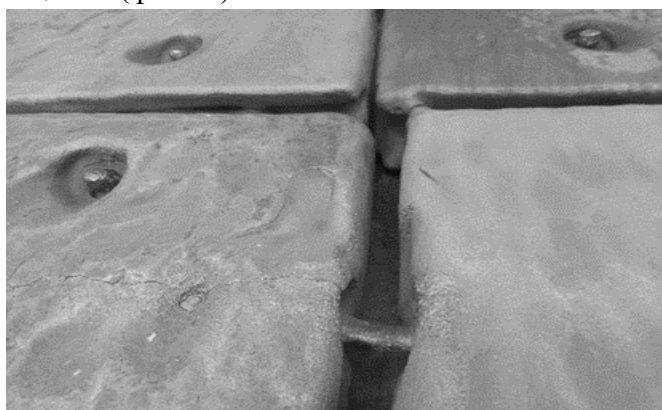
Разрушение листов металлооблицовки газохода СК «Союз-2»
